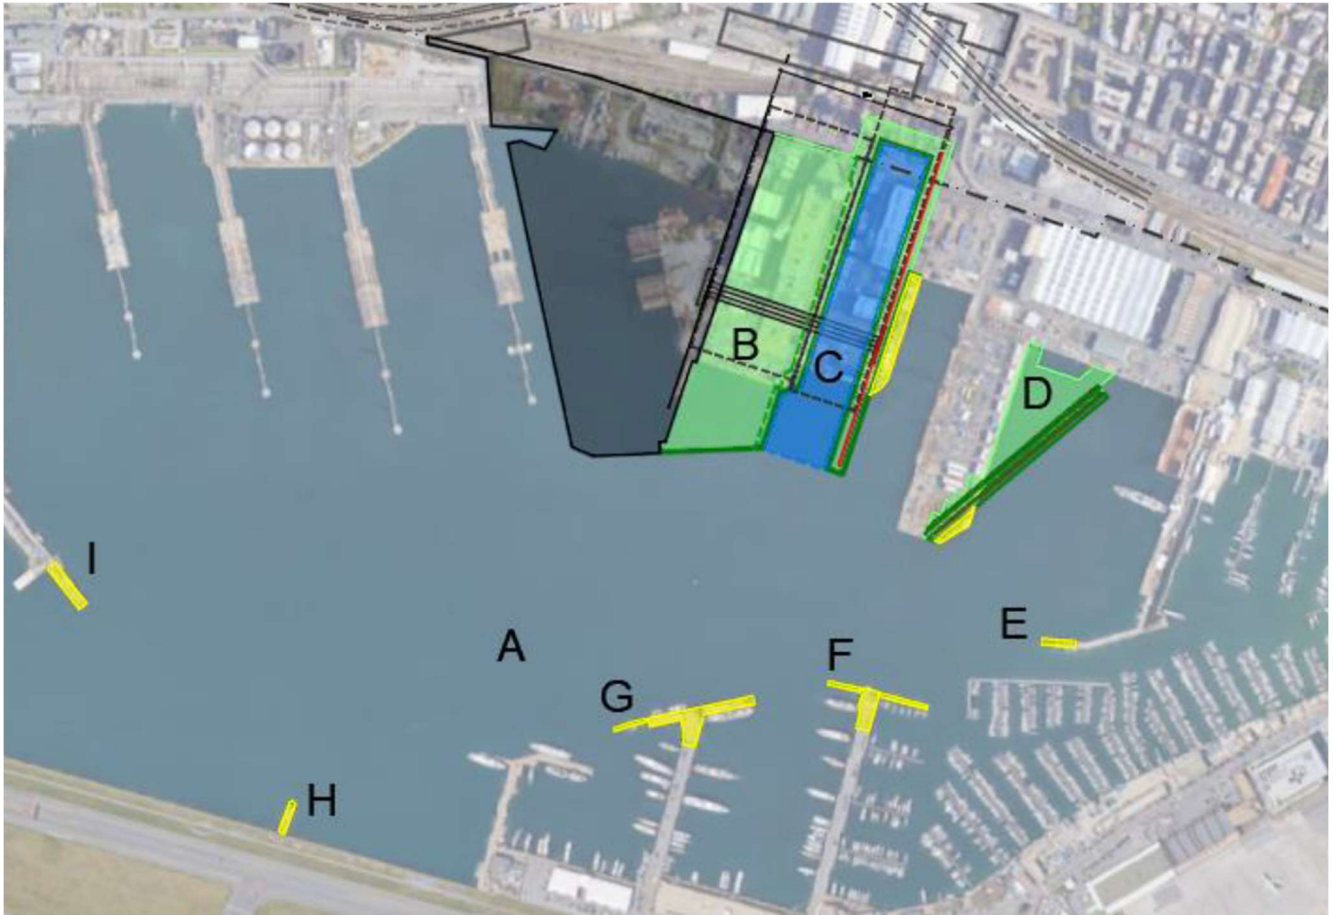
Planimetria di insieme degli interventi progettati, in nero l'area di intervento della Fase1 non interessata da questo studio di progettazione
